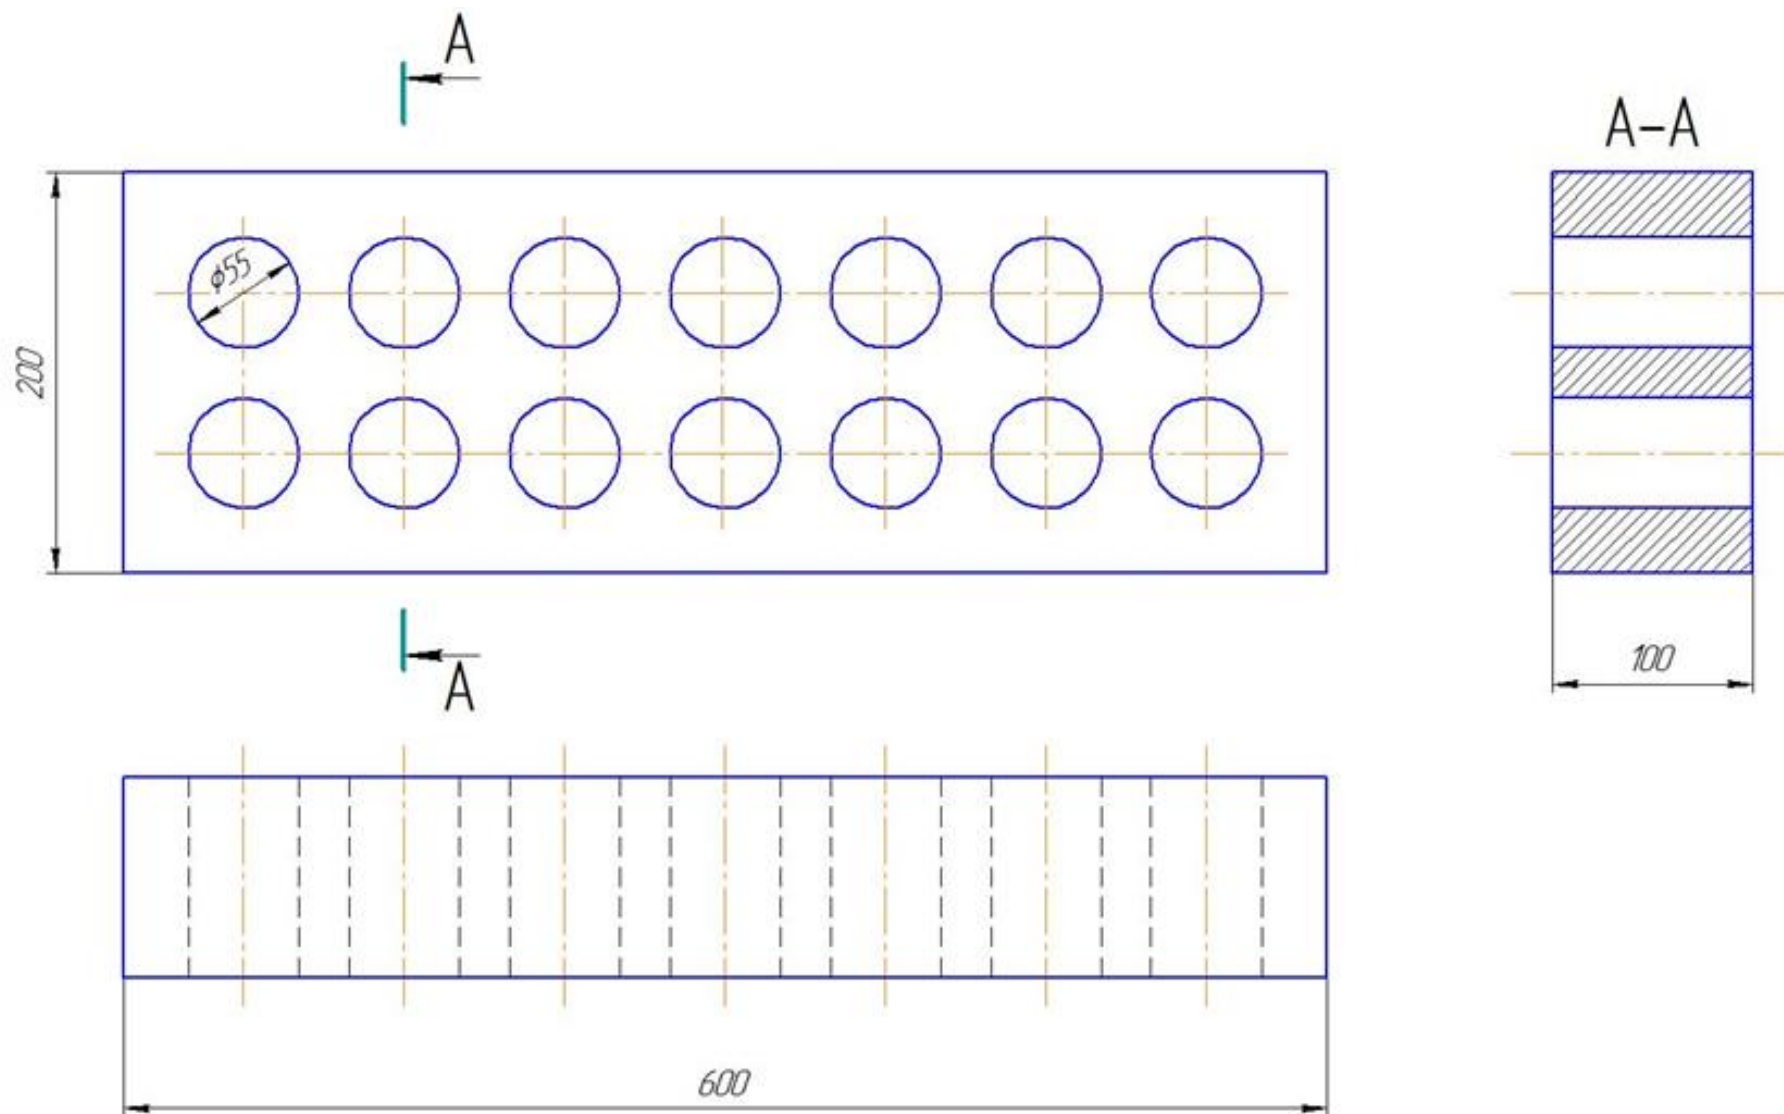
Креслення газобетонного блоку з 14-ма колоподібними отворами
